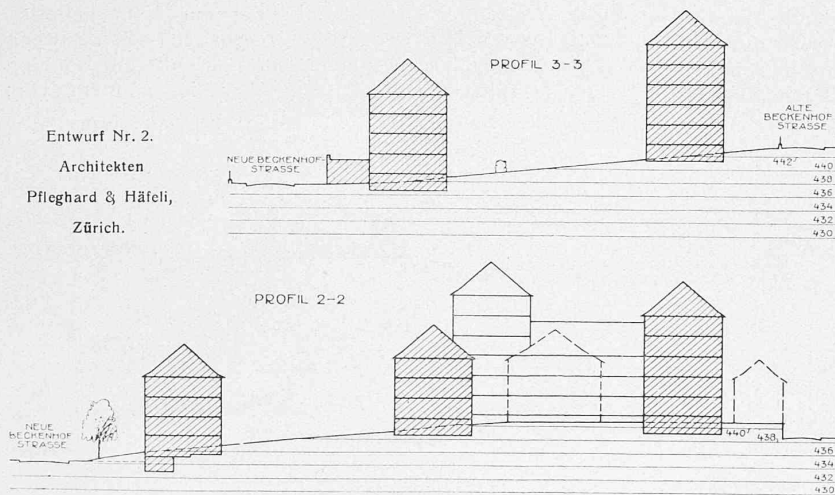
Profile 2 und 3 zum Lageplan Abb. 14. — Masstab 1:1000.
